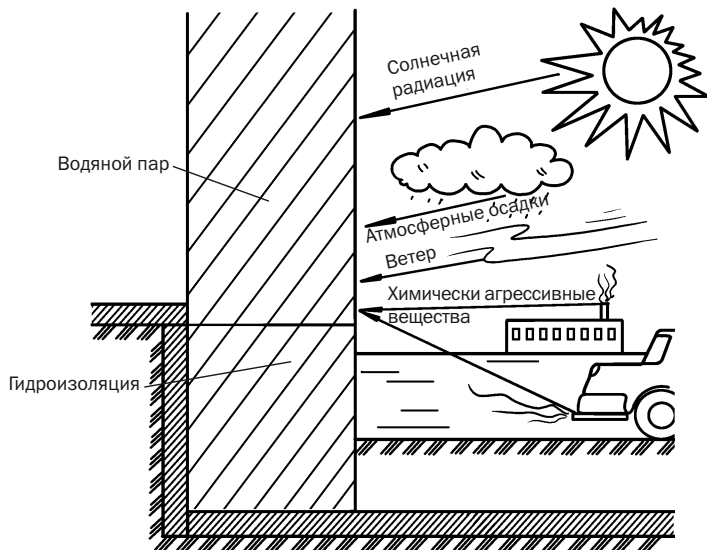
Нагрузки, которым подвергаются наружные стены и цоколь
